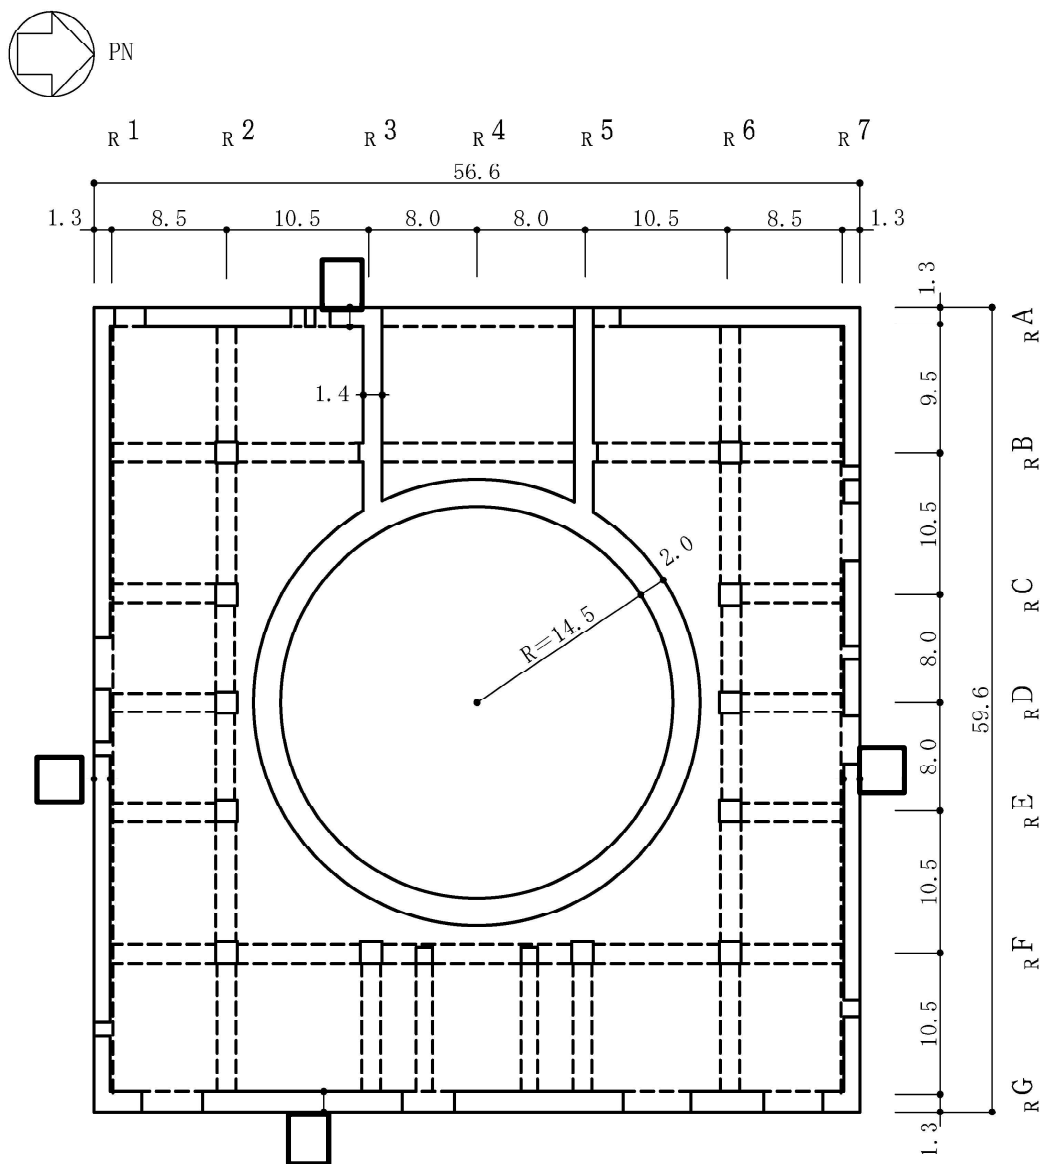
原子炉建屋の概略平面図 (1F, T.M.S.L. 12.3m) (4/9) (単位 : m)
